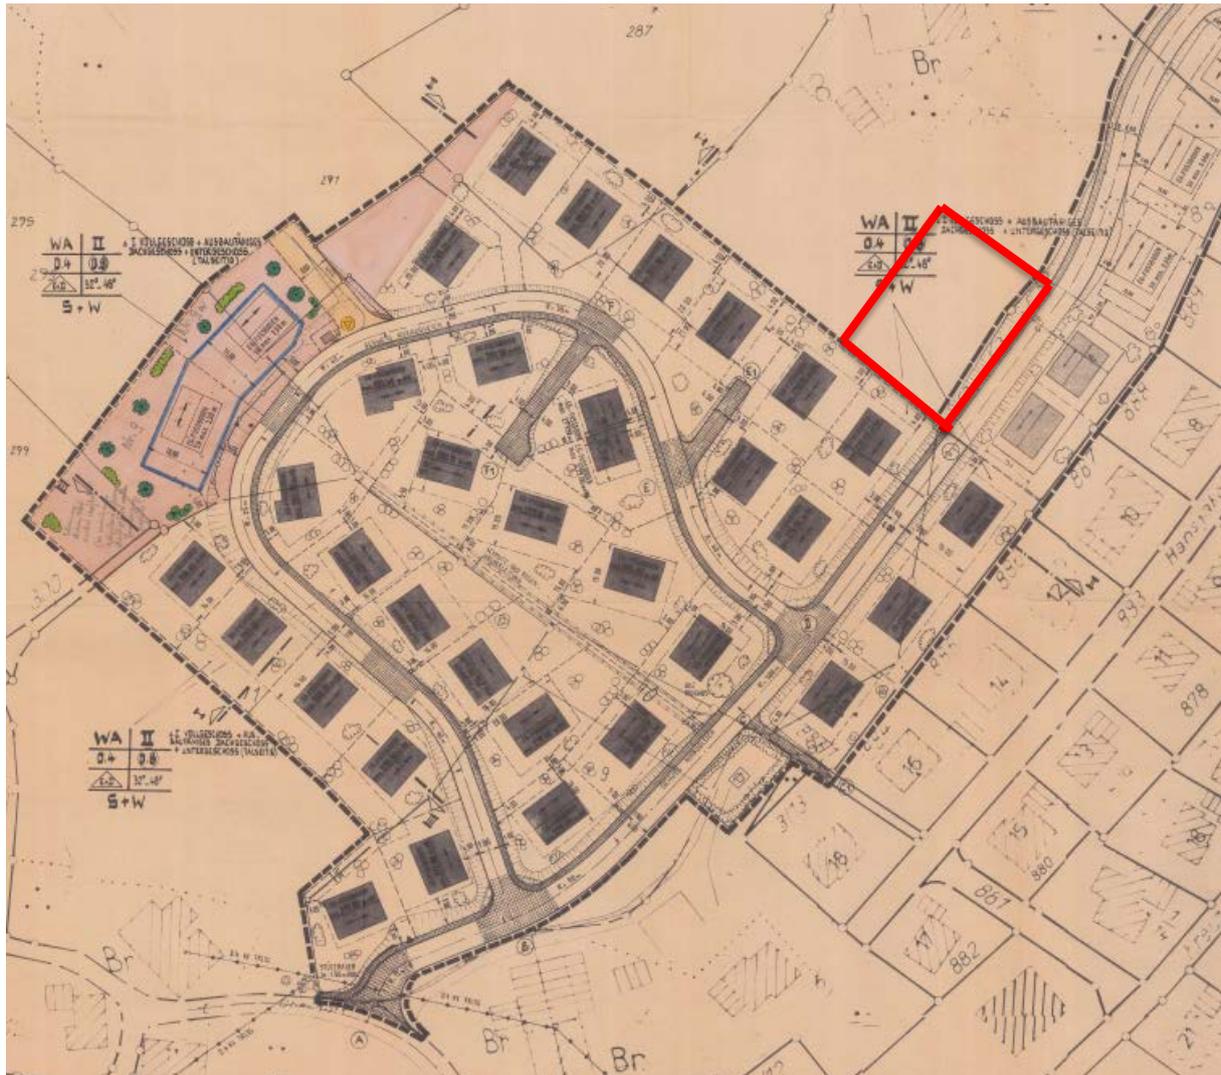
Bebauungsplan "Oberdorf, 3. Änderung" mit Markierung der geplanten Erweiterung; eigene Darstellung
